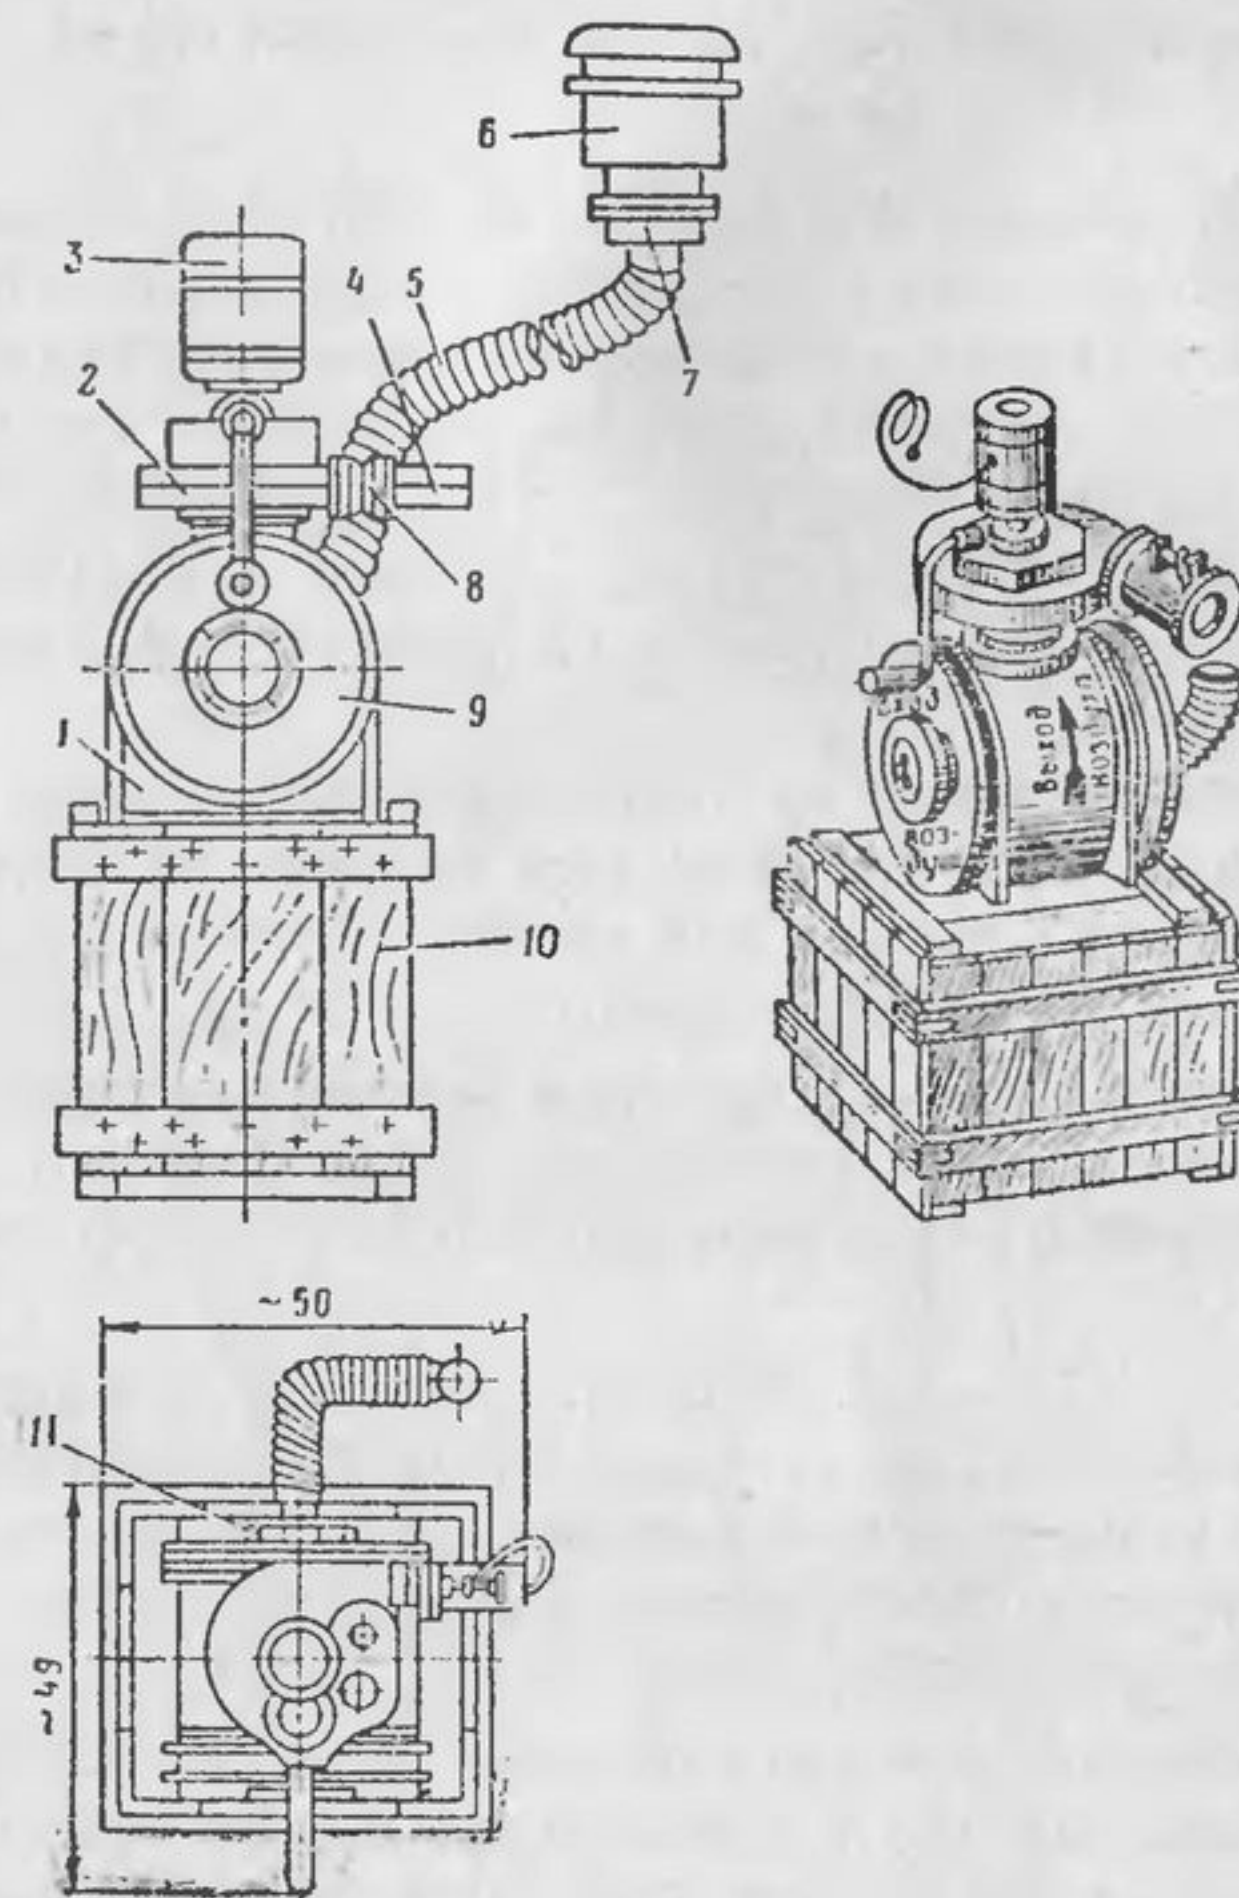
Фильтровентиляционный агрегат ФВА-50/25:
